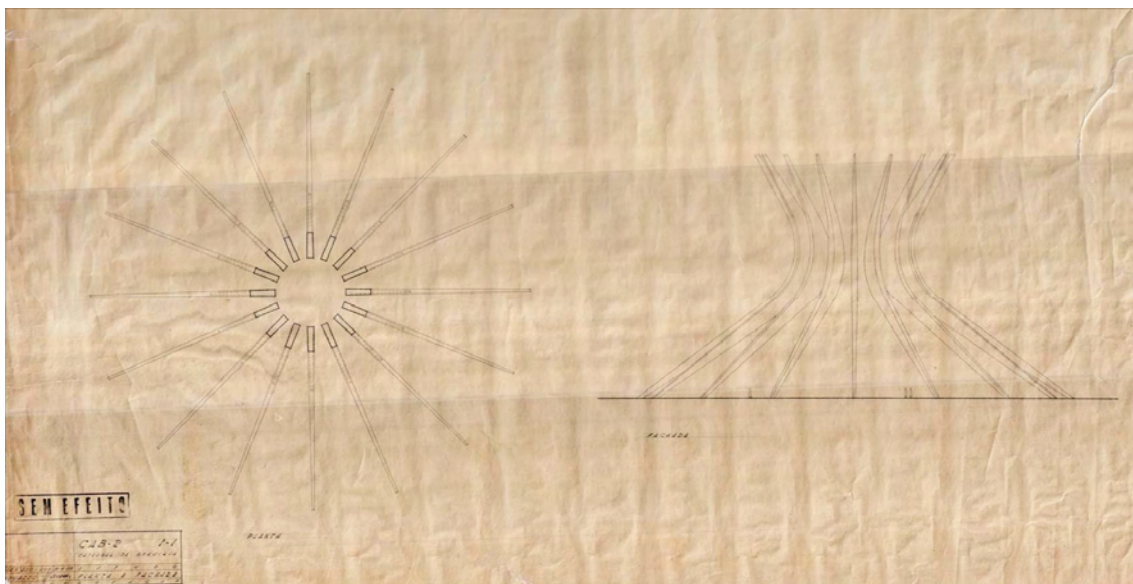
Projeto – Planta e Fachada. 17 abr. 1958.
